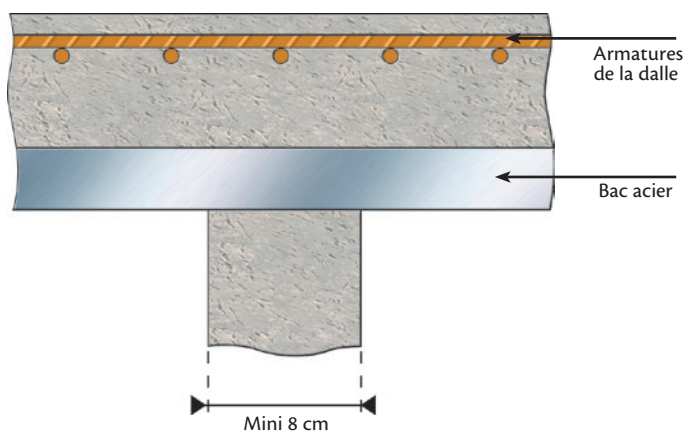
Appui de franchissement sur béton ou maçonnerie
